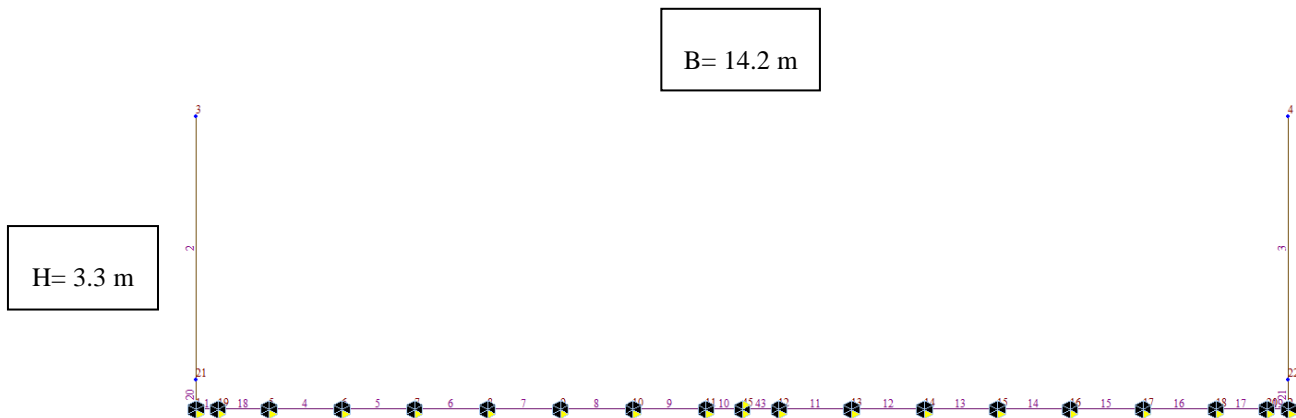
Numerazione dei nodi e dei frame nel 1° modello strutturale su letto di molle con vincolo centrale allo spostamento orizzontale
